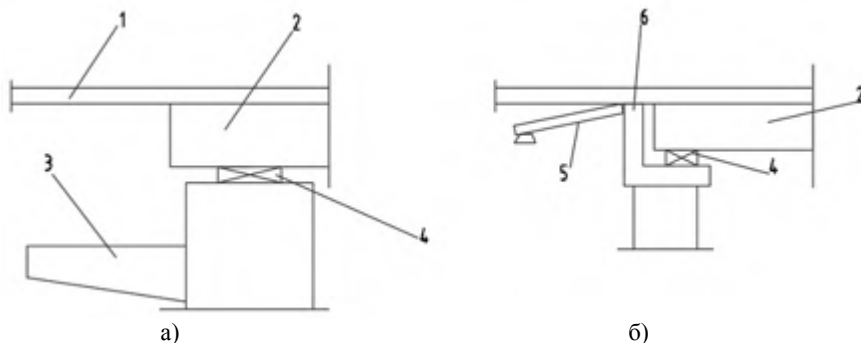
Способы улучшения условий сопряжения путепроводов с насыпью подхода: а – с использованием разгружающей площадки; б – с применением переходной плиты; 1 – покрытие проезжей части; 2 – пролетное строение; 3 – разгружающая площадка; 4 – опорная часть; 5 – переходная плита; 6 – деформационный шов
